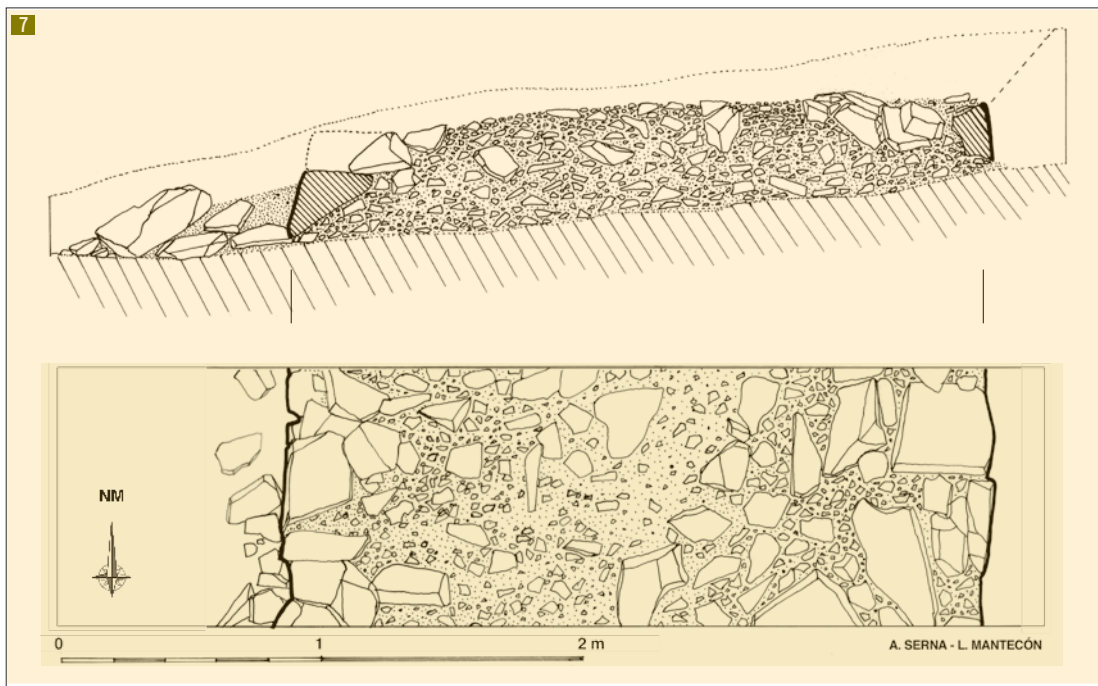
Sección transversal (arriba) y planta (centro) del sector excavado de la *via praetoria*.
